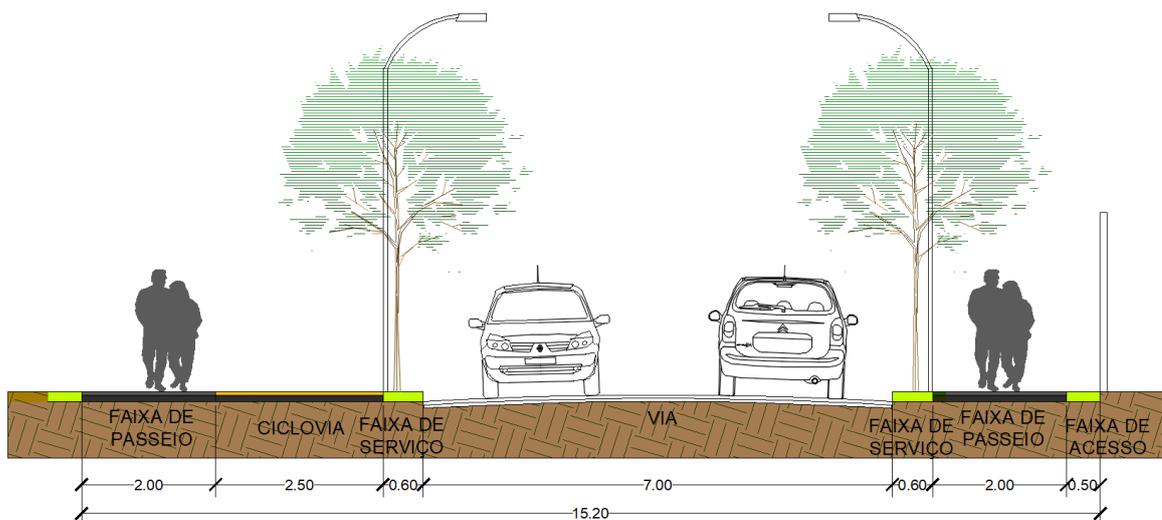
Perfil da Via de Circulação de Vizinhança 1 – Perfil 1 Limítrofe a ELUP (Fonte: Própria)
